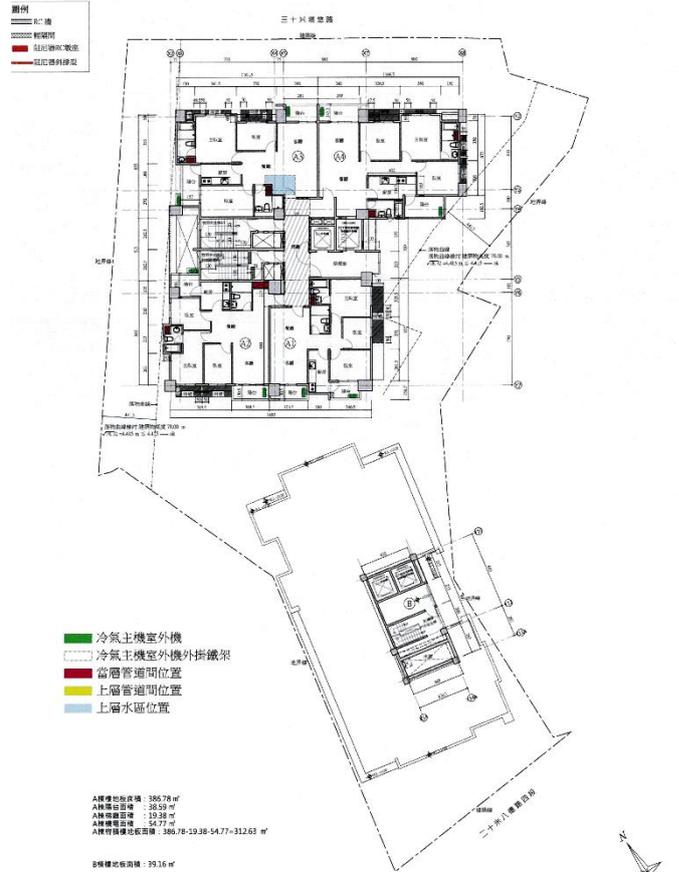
十六層平面圖、B 棟屋突一層平面圖 (S : 1/300)
